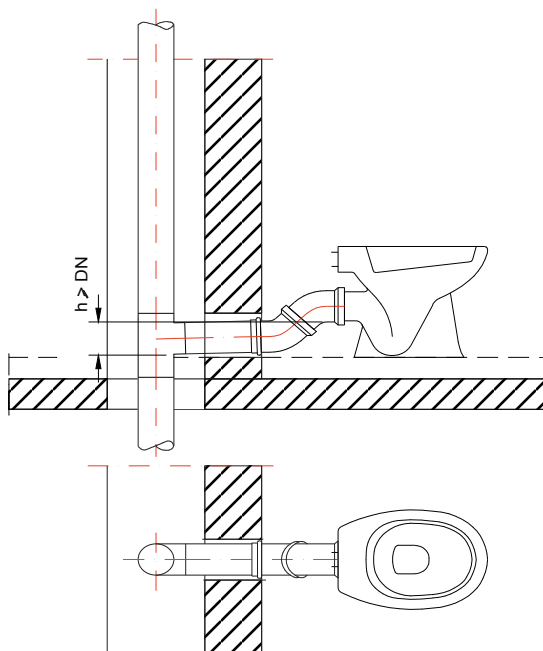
Ungünstiger Anschluss eines stehenden Klosetts an eine Falleitung
